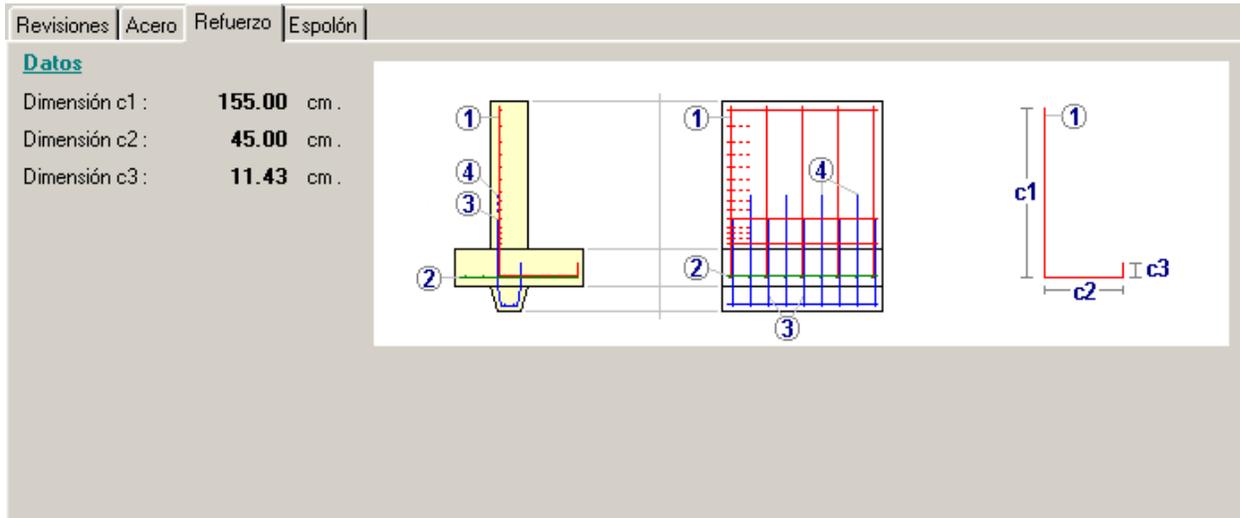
Cálculo de Muro Bajo en "T" con sobrecarga.
